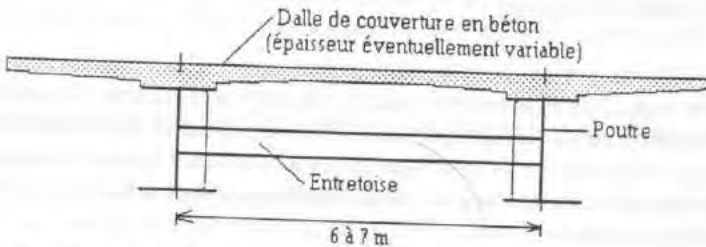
Coupe schématique d'un pont-mixte bipoutre à entretoises.
